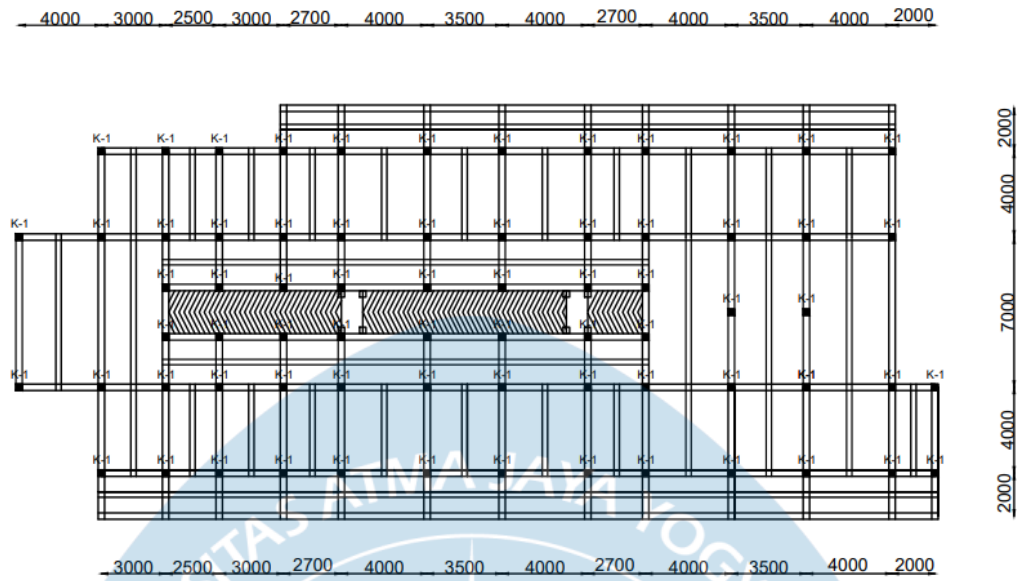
19 Layout Denah Balok Induk Unit 3
